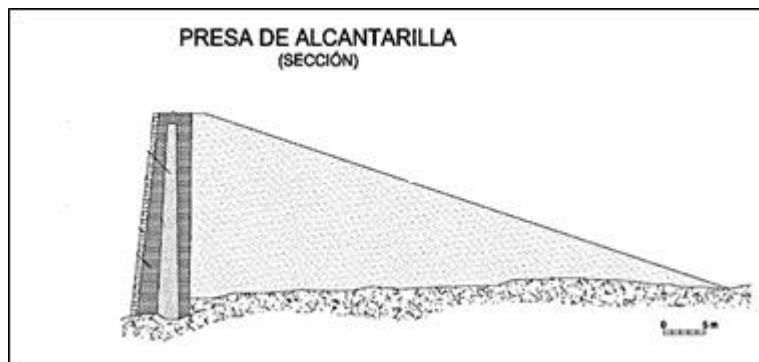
Perfil transversal da barragem de Alcantarilla (Gutiérrez et al., 2006).
